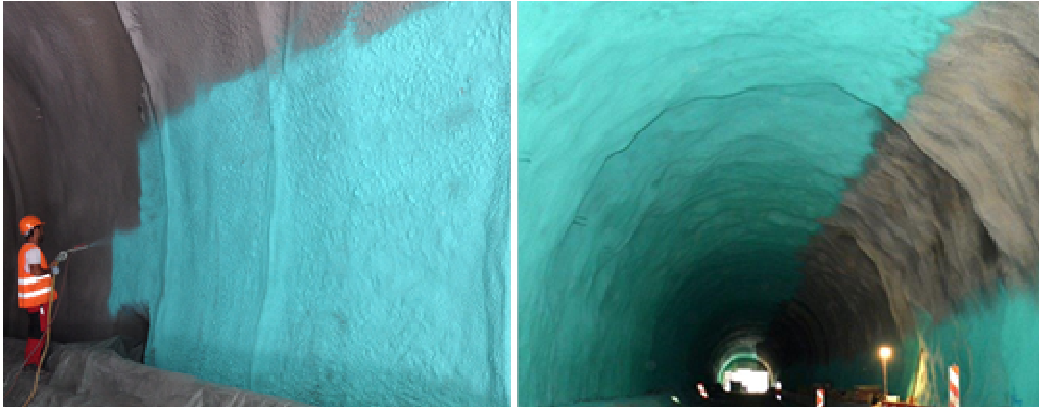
Pohľad na MAPEPLAN PROTECTION finálnu aplikáciu striekaním
